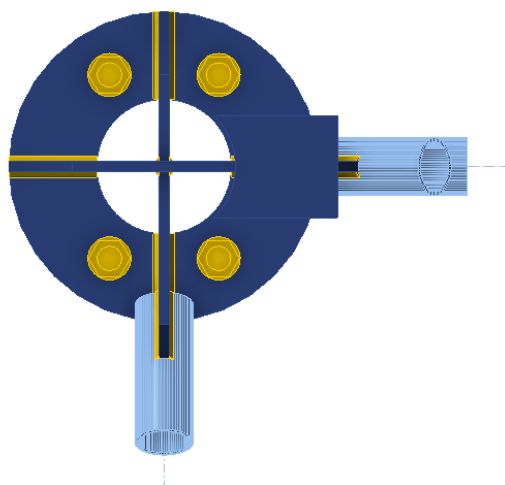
Розріз монтажної стики верхнього поясу просторового блоку ферми
